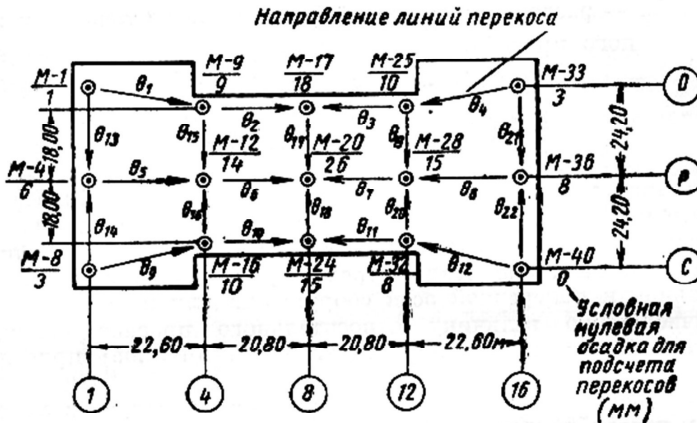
План расположения нивелирных марок с направлениями перекосов конструкций фундамента
